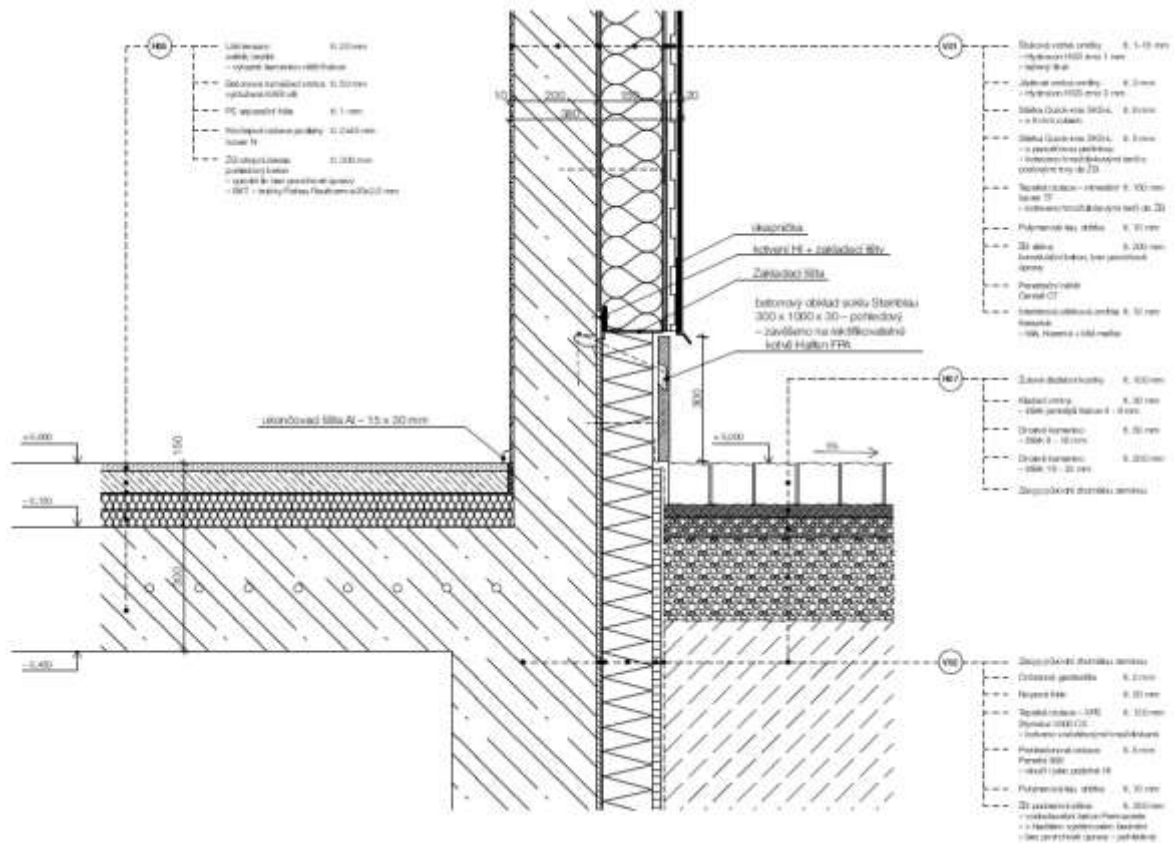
detail ukončení hydroizolace nad U.T.
